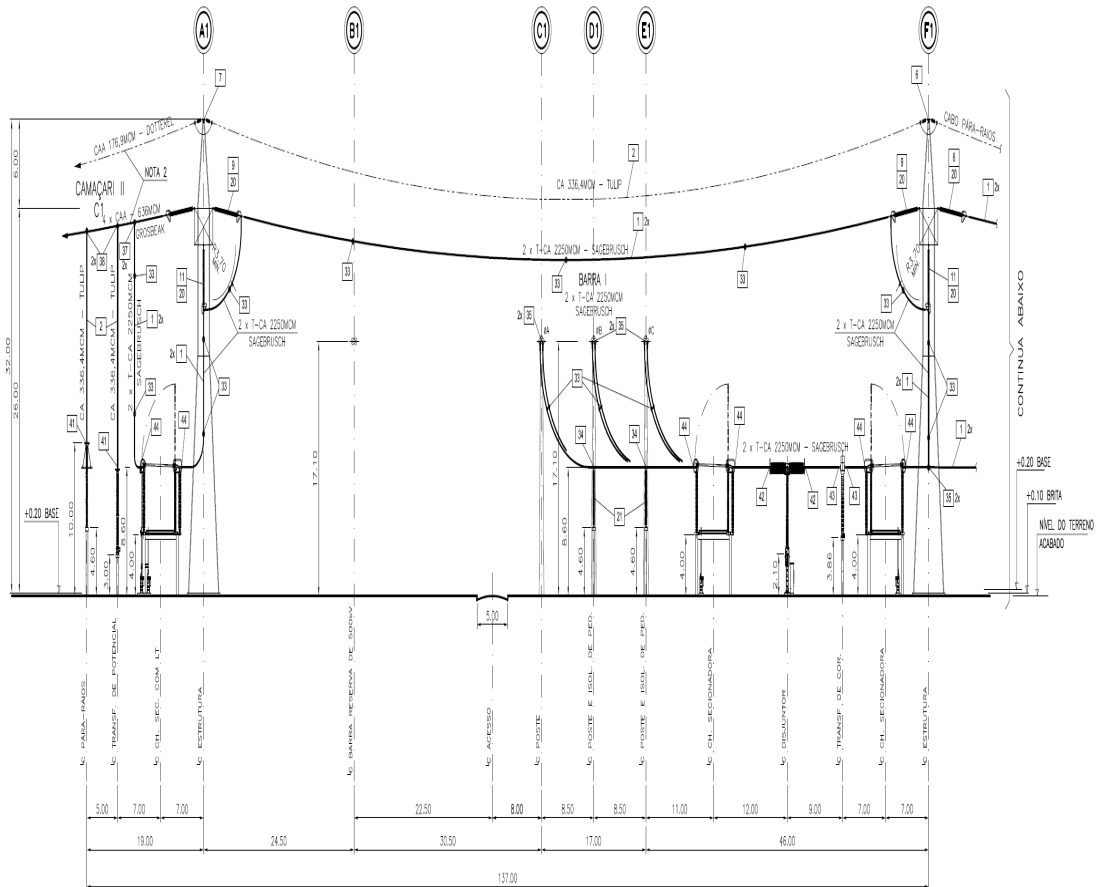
Planta de Corte da SE Camaçari IV 500 kV - Corte A-A (Continuação).
